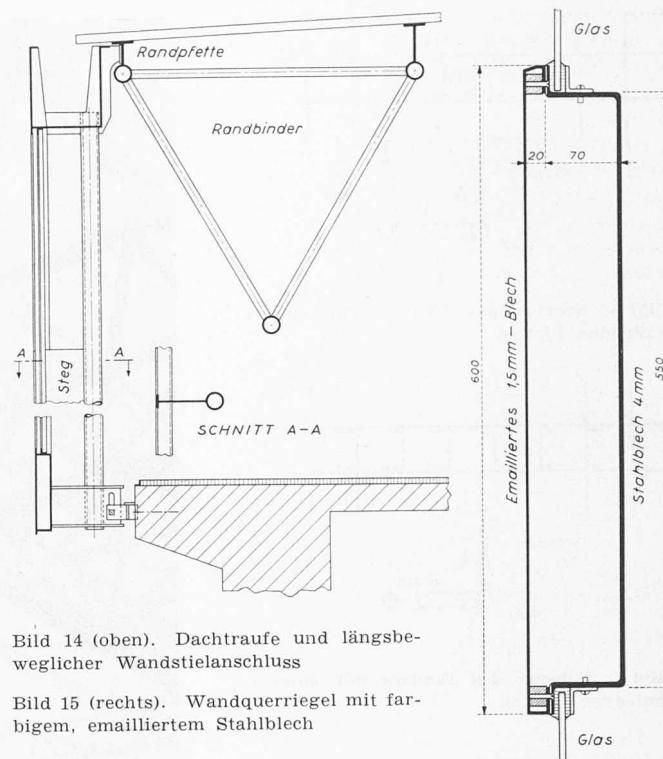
(oben). Dachtraufe und längsbeweglicher Wandstielanschluss
